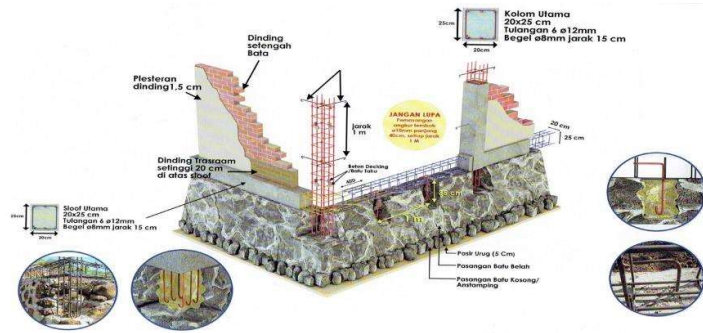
Bentuk Hubungan Balok-Kolom Yang Disarankan Untuk Bangunan Tahan Gempa (Sumber: Boen (2010))
